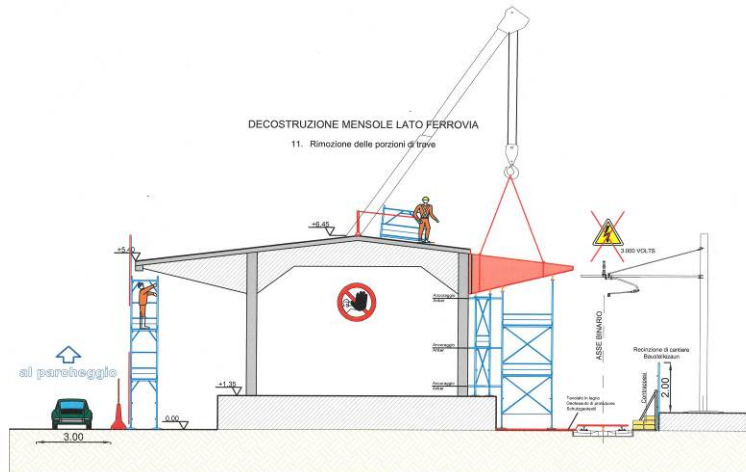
Sezione Demolizione Edificio A9 – Rimozione porzione di trave
